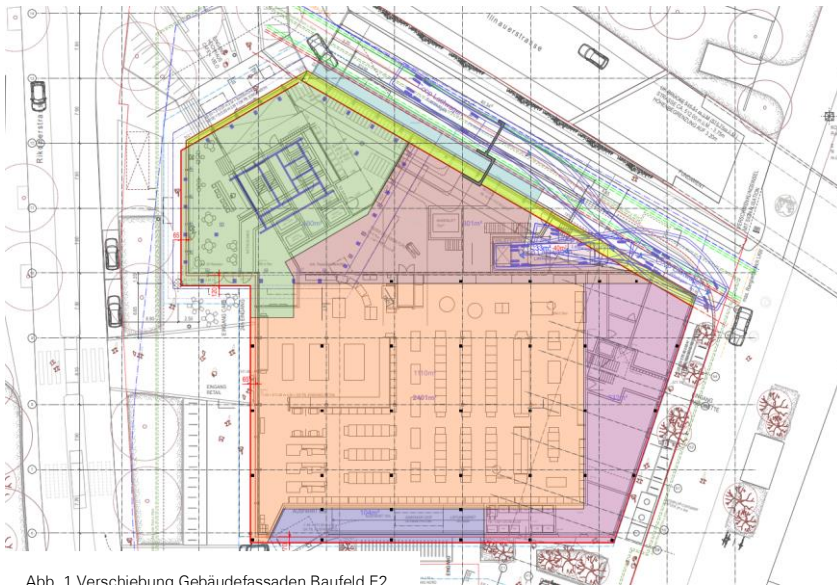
Verschiebung Gebäudefassaden Baufeld E2
